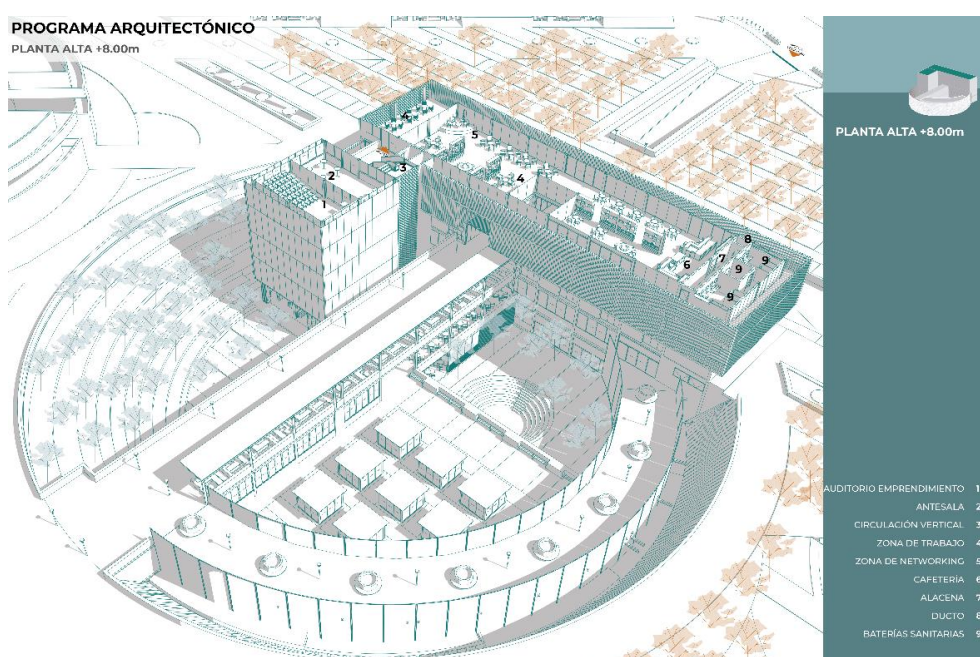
Programa Arquitectónico Planta Alta +8.00m (Abad, D. 2021)
